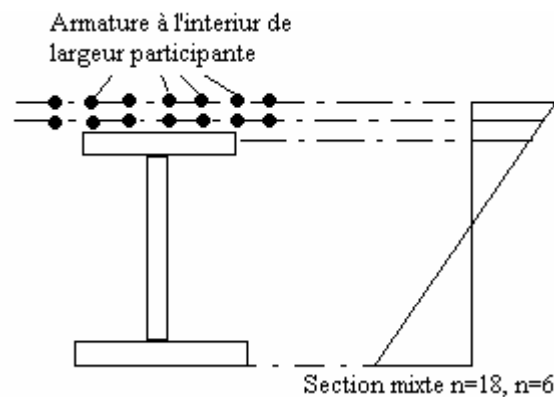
les contraintes dans la section mixte (poutre plus armature passive)
